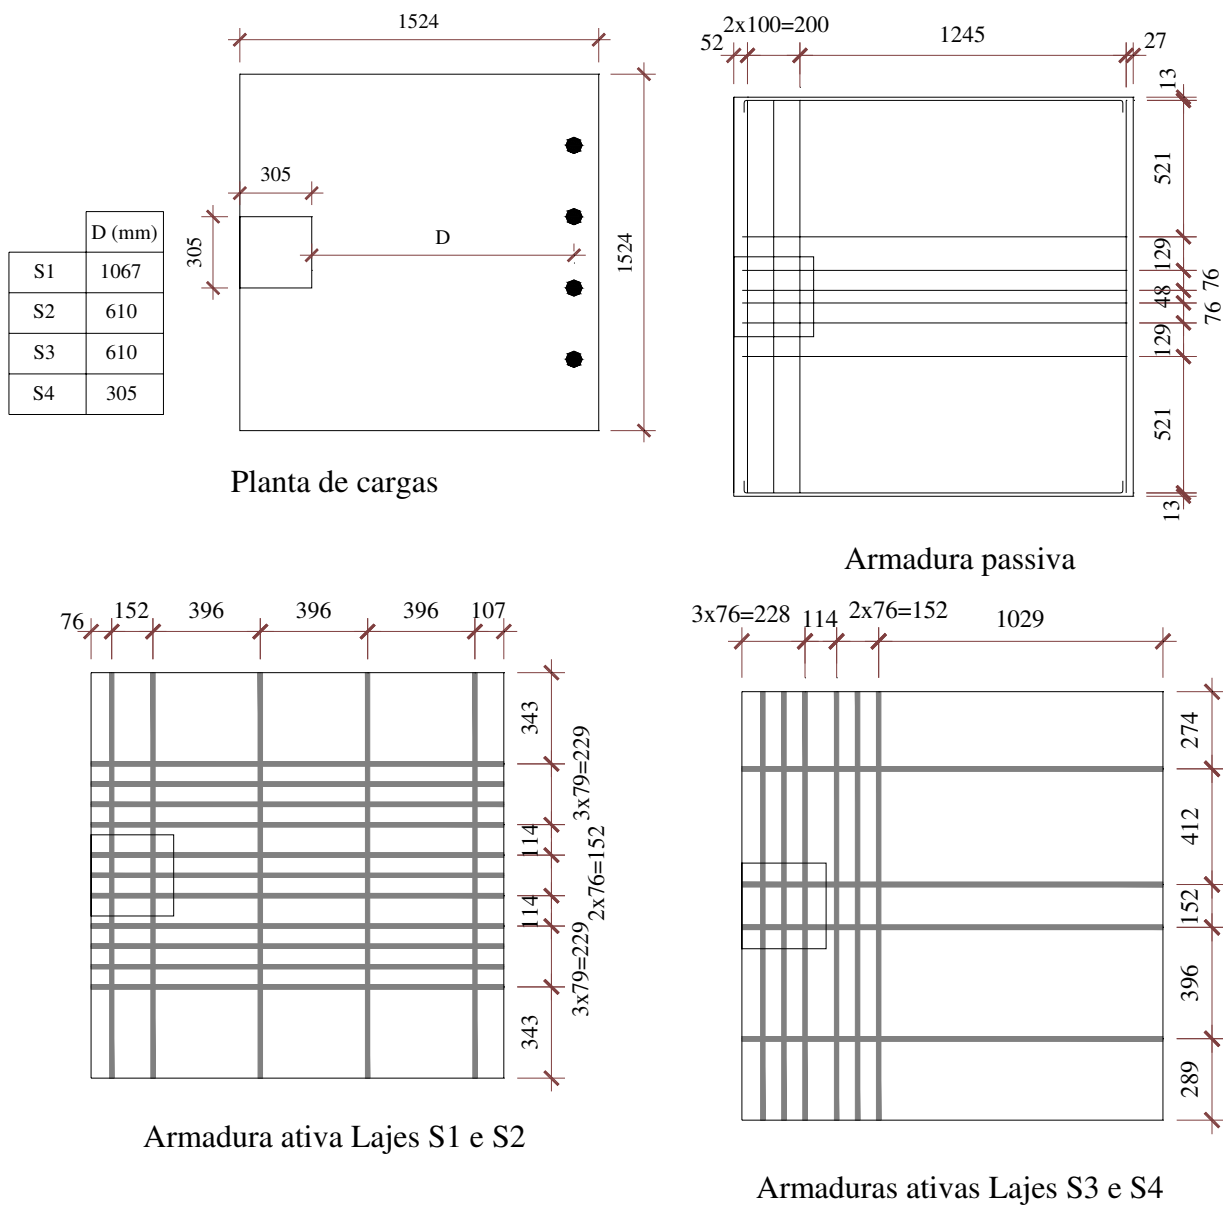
Detalhes das armaduras e posição dos carregamentos para todas as lajes.
